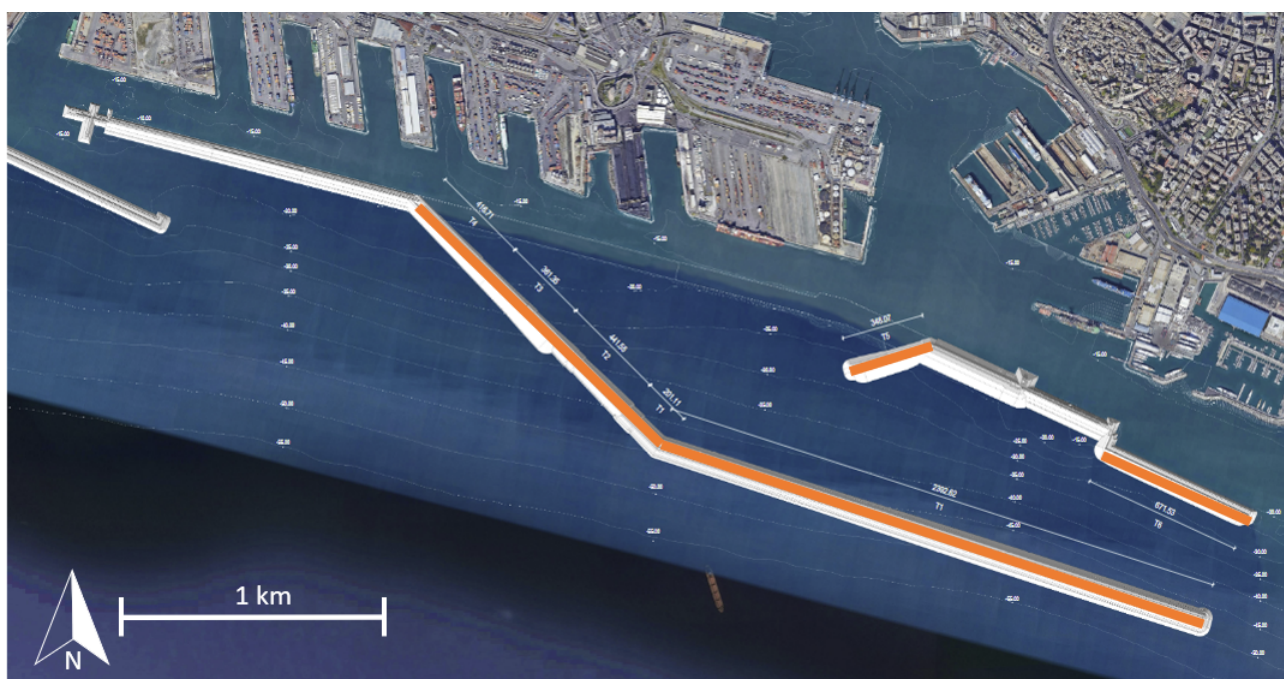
Planimetria di progetto - In arancione le aree interessate dalle attività previste nella Fase A
